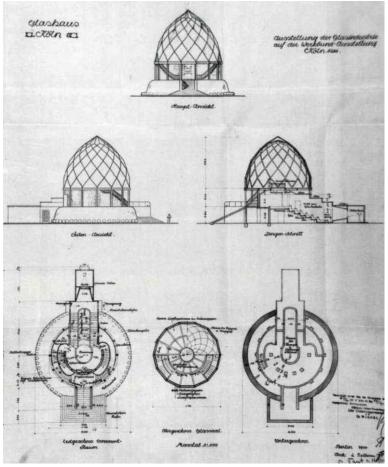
alzado, planta y perfil de todo el conjunto del *Pabellón de Cristal. Colonia 1914.
